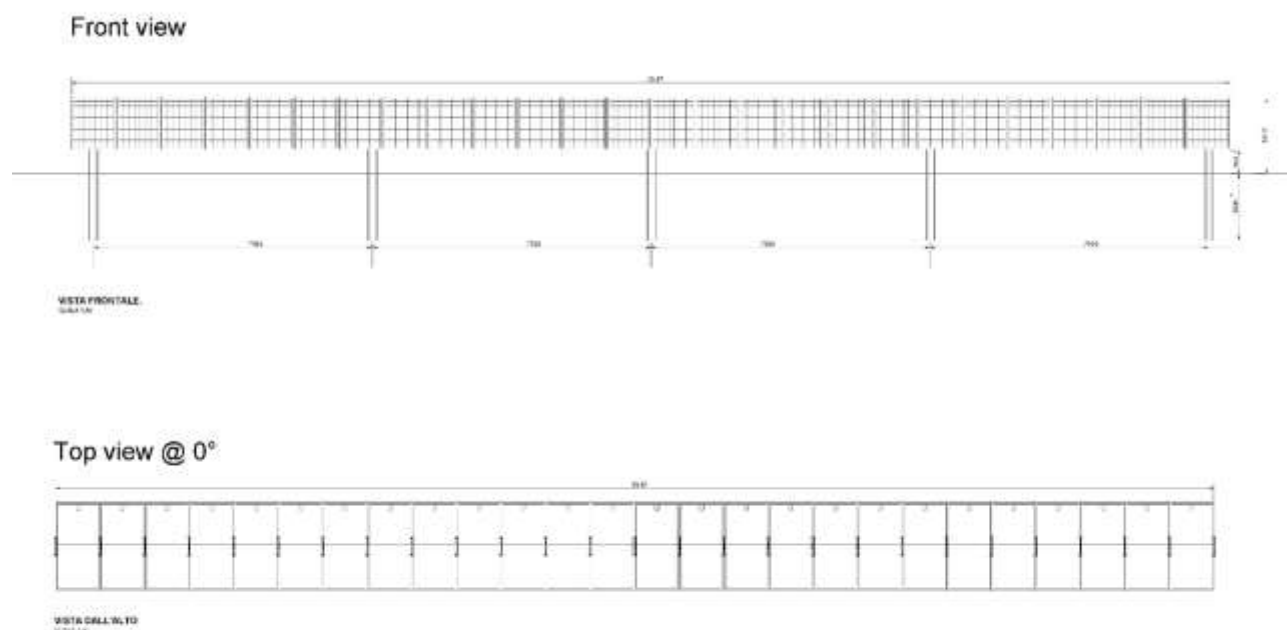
Vista laterale e vista dall'alto della singola stringa da 26 moduli
